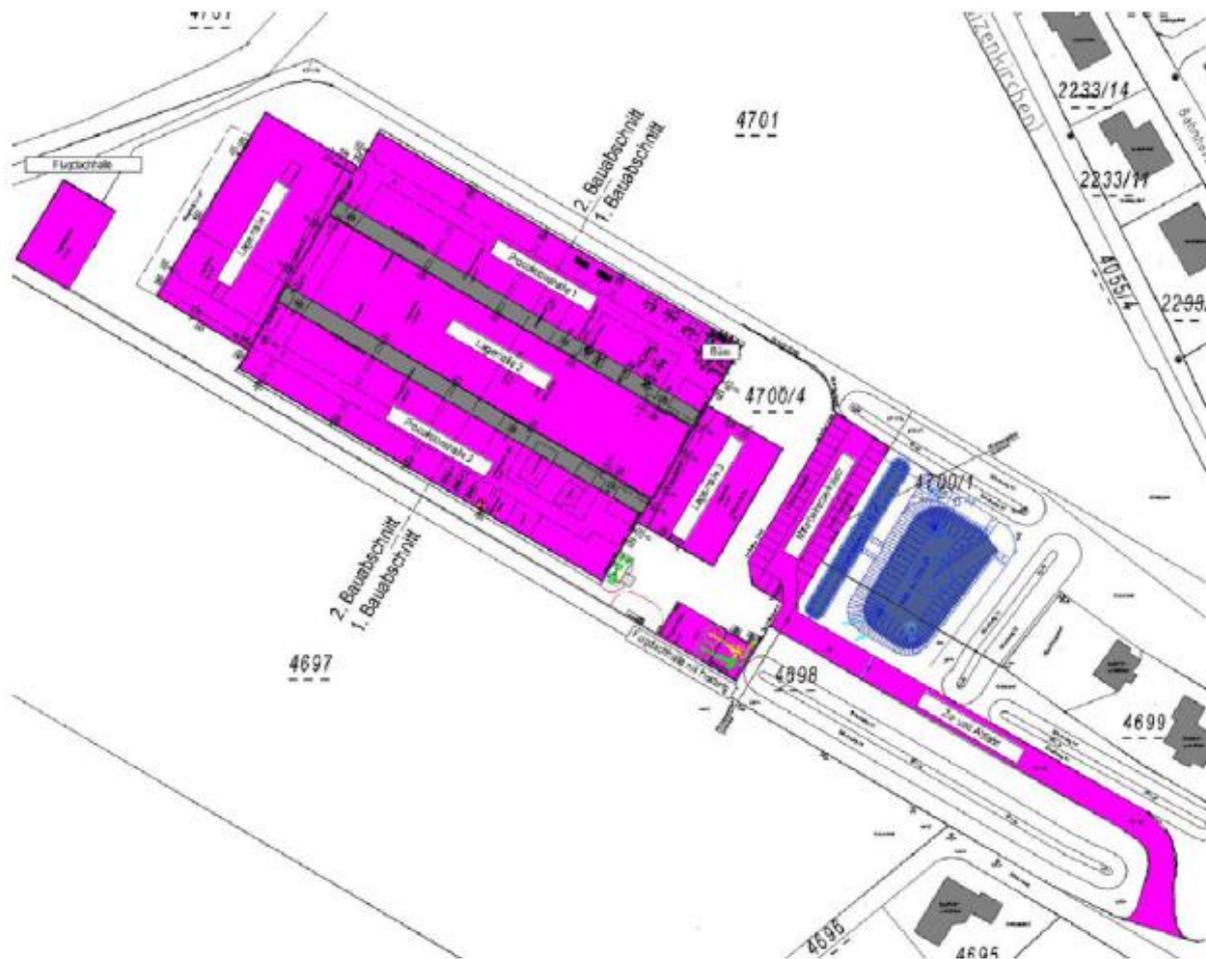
Lageplan der geplanten Betriebsstätte der Fa. Eschlböck
